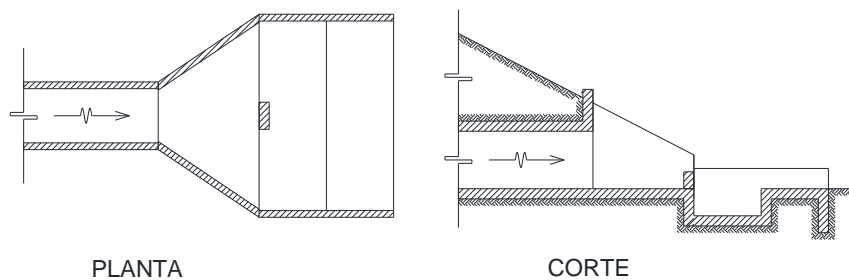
Terminal de alcantarilla con batea de gaviones.
